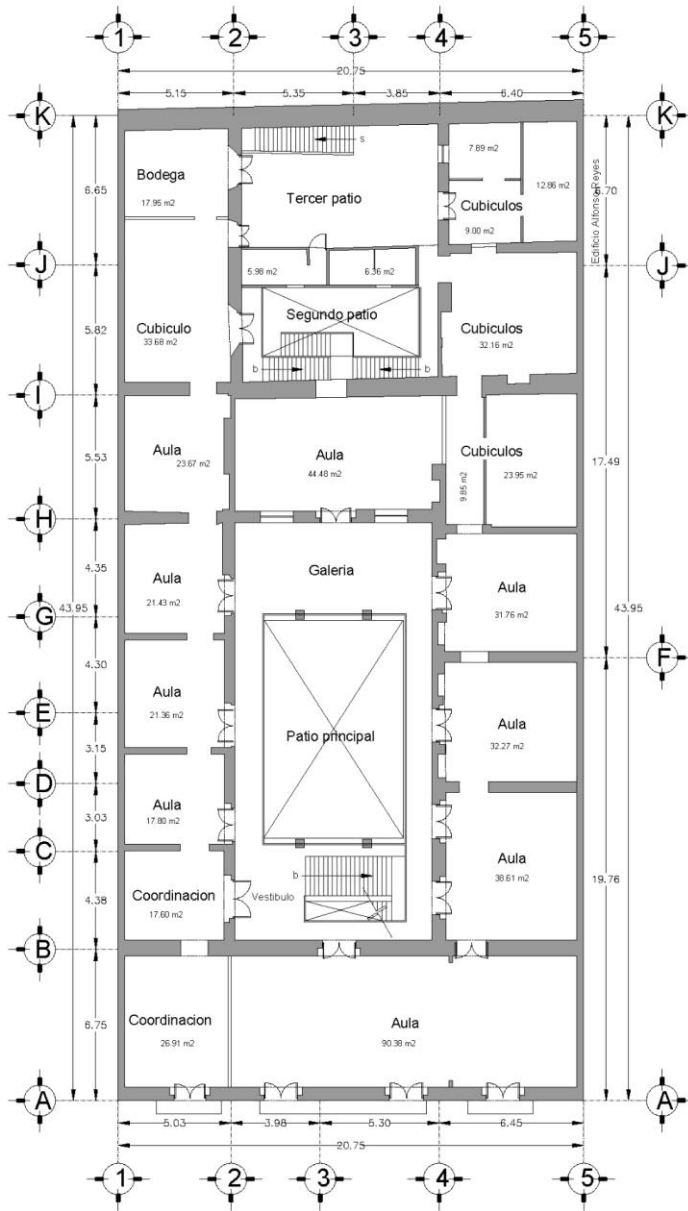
Planta arquitectónica alta, Edificio Flores Magón. Elaboración propia.
